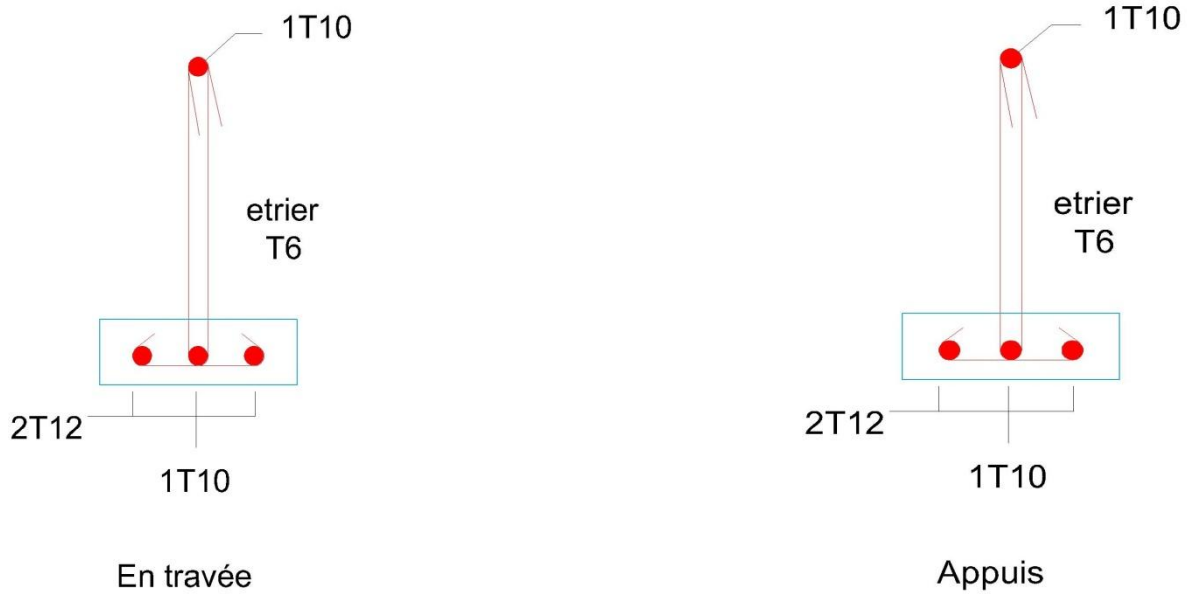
Schéma de ferrailage des poutrelles type 3 de l'étage habitation et terrasse accessible
